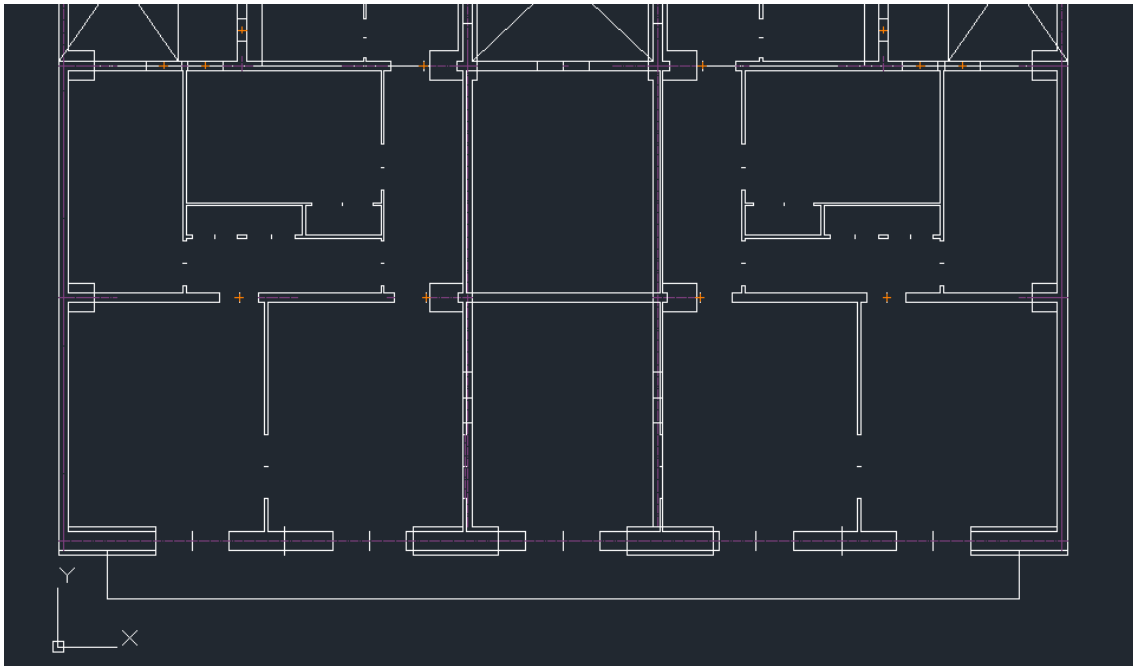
12 Superposición de los muros de fachada de planta baja y de la planta tipo
